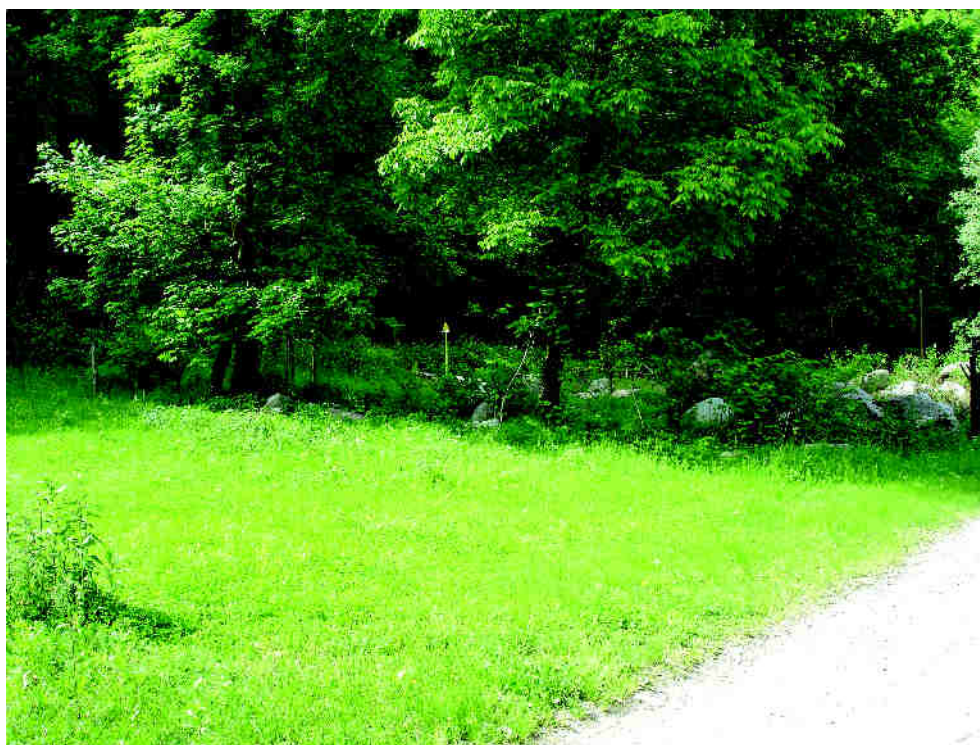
Foto inserimento n°1: vista delle opere di presa dalla pista di accesso all'area
